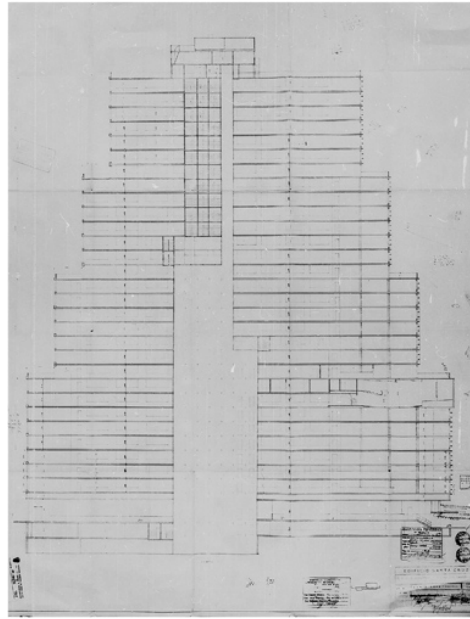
Edifício Santa Cruz, corte e planta baixa, executado por Ernesto Woebcke
